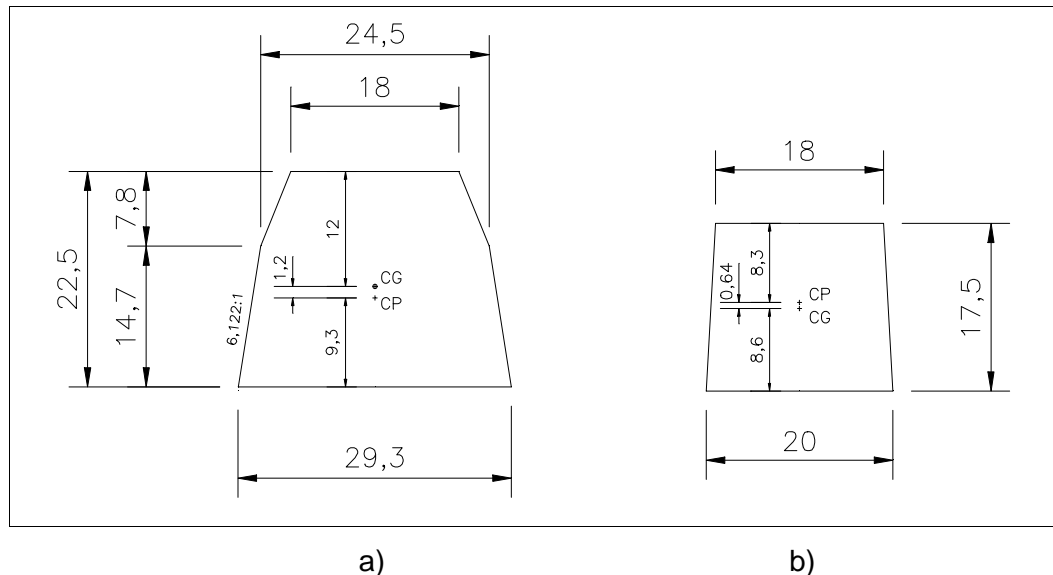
Dimensões (cm) das seções transversais e excentricidades:
